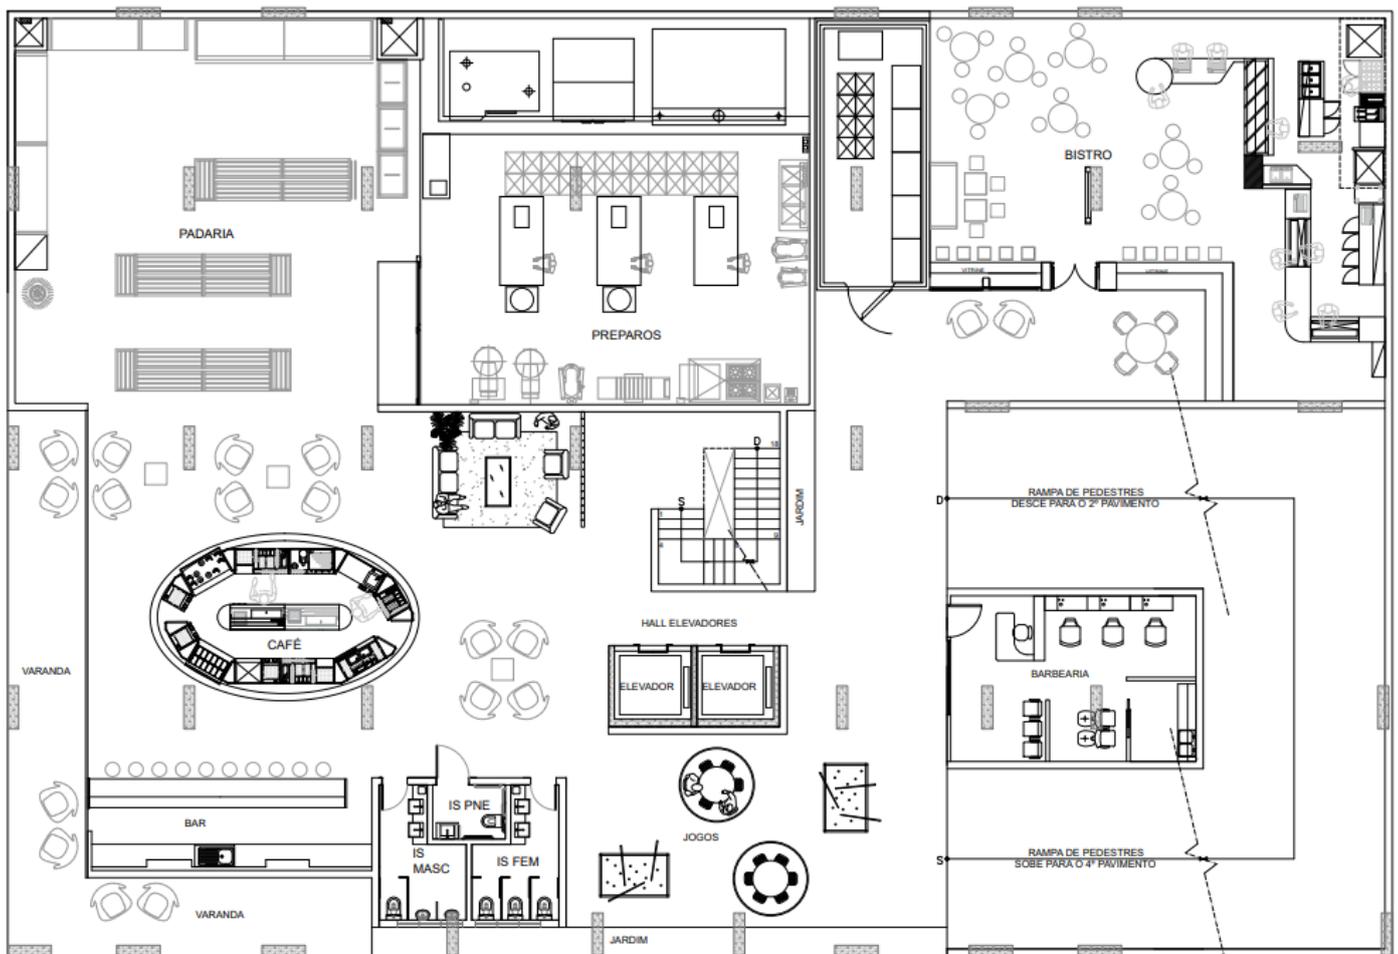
BLOCO COMERCIAL - 3º Pavimento
